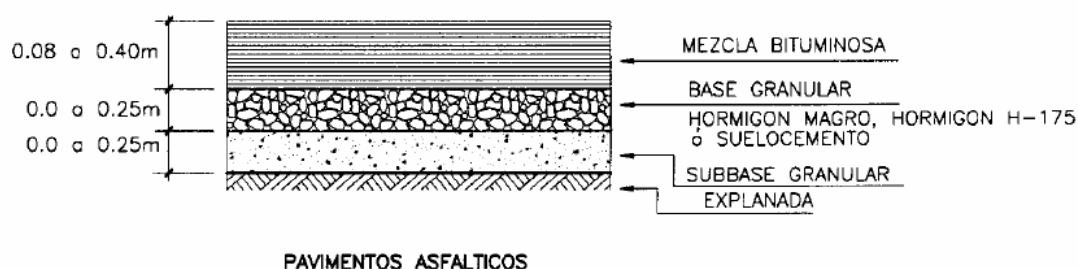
Sección tipo. (Fuente: ROM 4.1-94)
